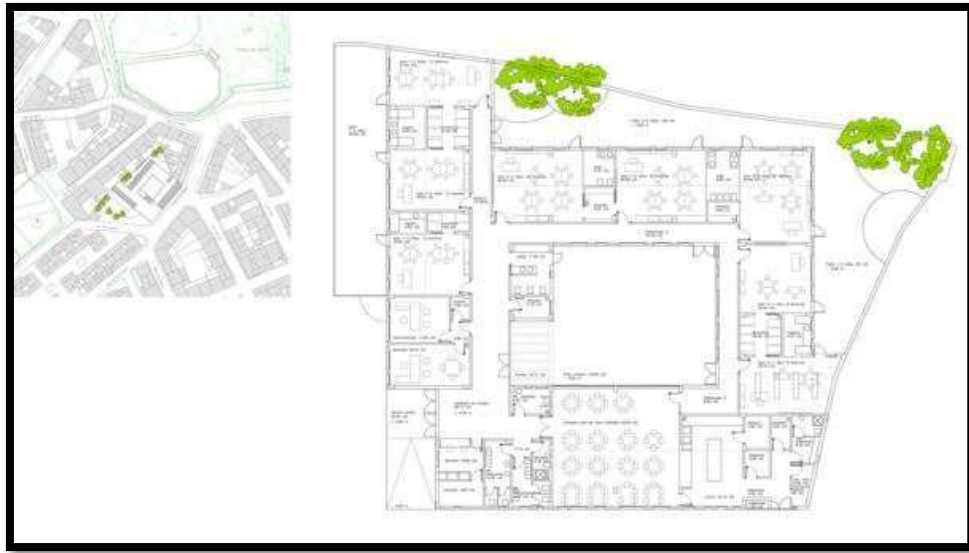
Planta Arquitectónica y Planta de Conjunto.
